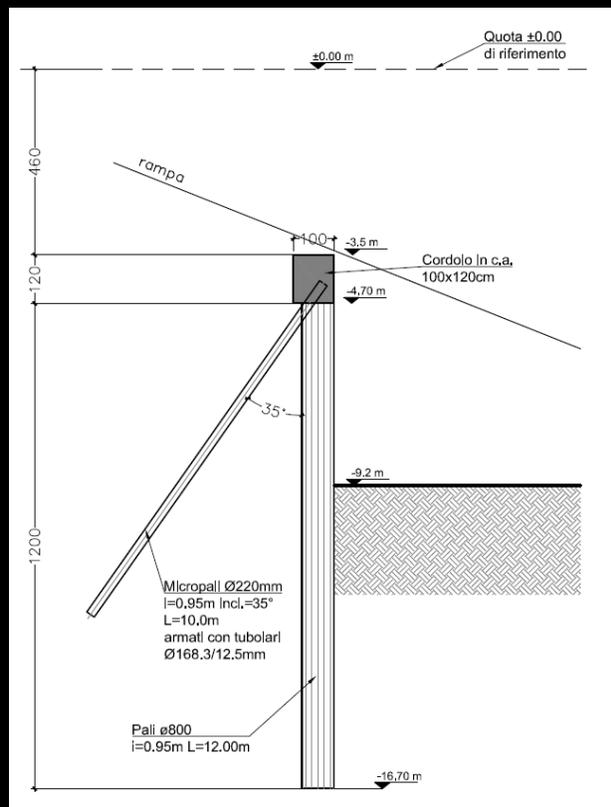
SEZIONE DI PROGETTO A CAVALLETTO (ZONA RAMPA)
